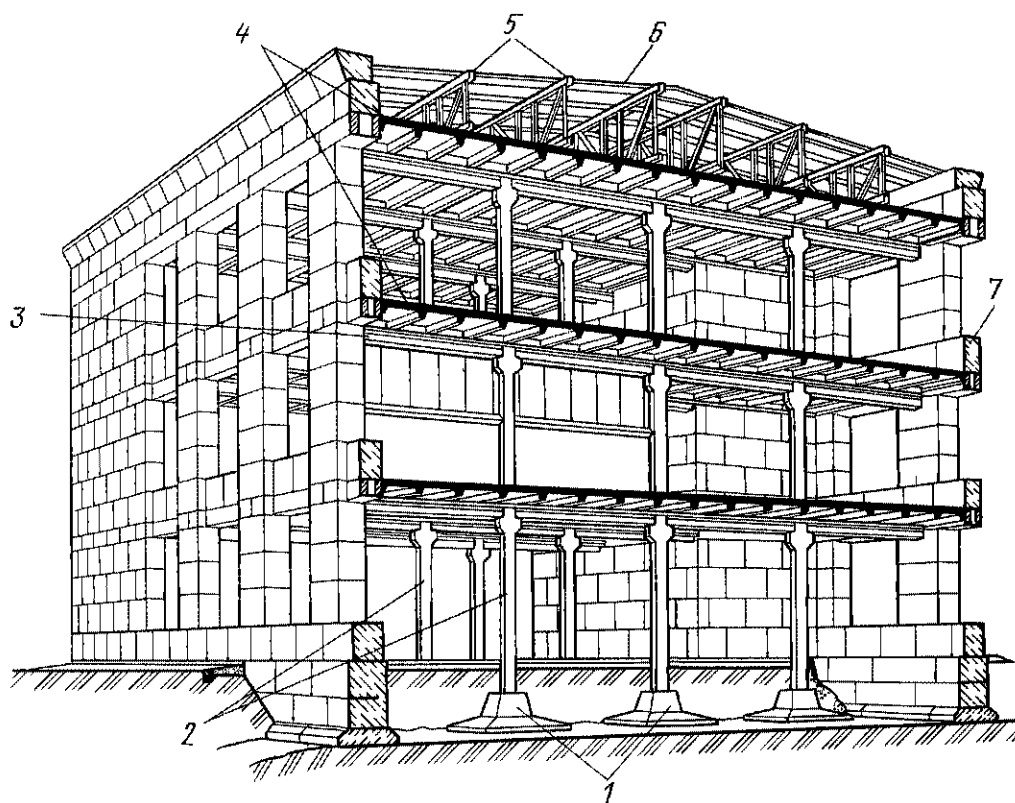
Многоэтажное каркасное здание с балочными перекрытиями. 1 — фундаменты; 2 — колонны; 3 — ригели (главные балки); 4 — плиты перекрытий; 5 — несущие конструкции покрытия; 6 — плиты покрытия; 7 — несущая стена из крупных блоков.
